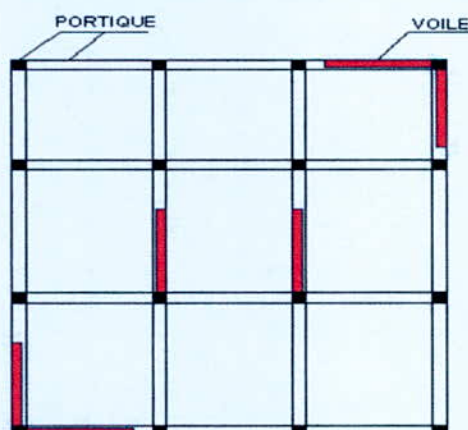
Structures « mixtes » avec des murs porteurs.
